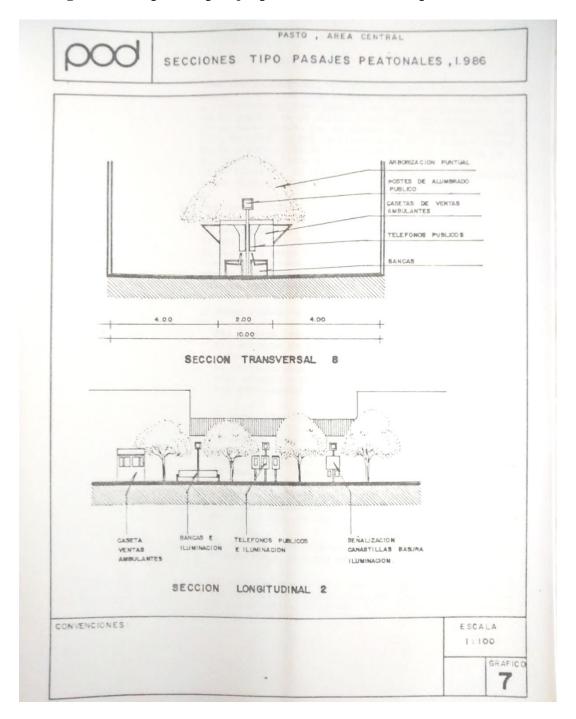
Propuestas pasajes peatonales zona centro plan POD 1985
